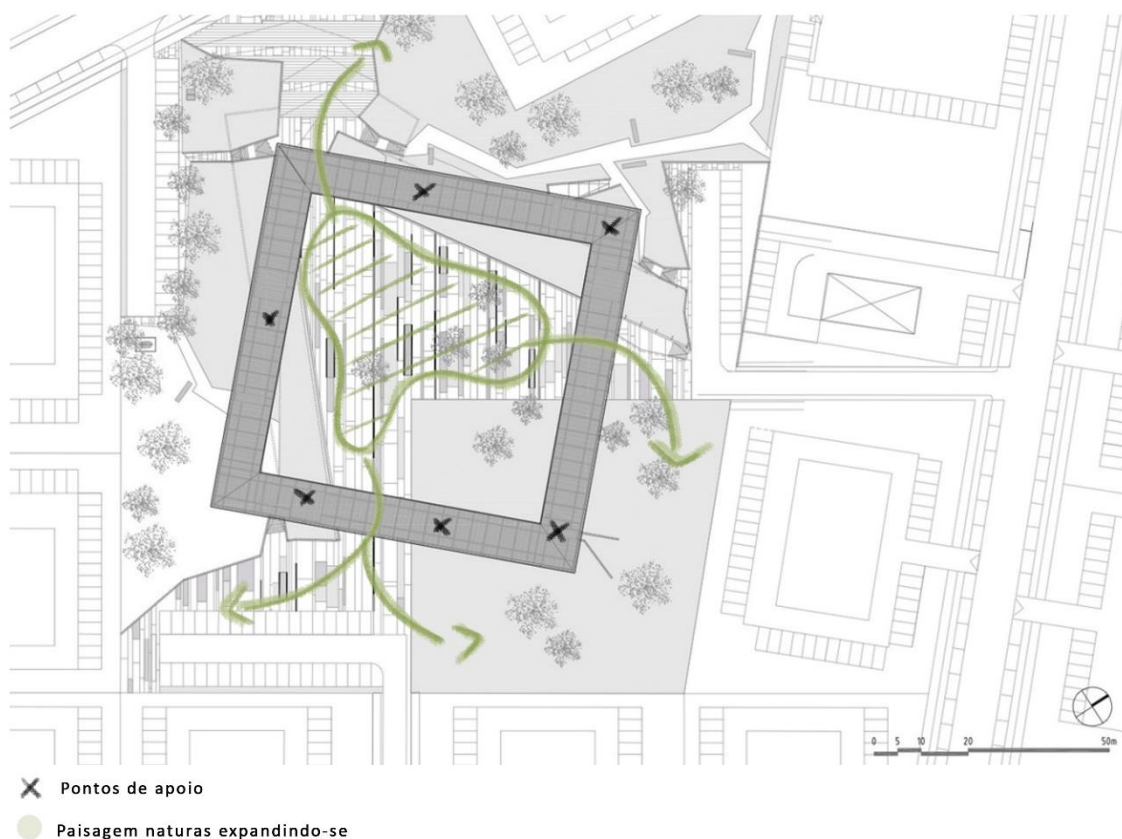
Planta de cobertura com análise de ligações e pilares estruturais
